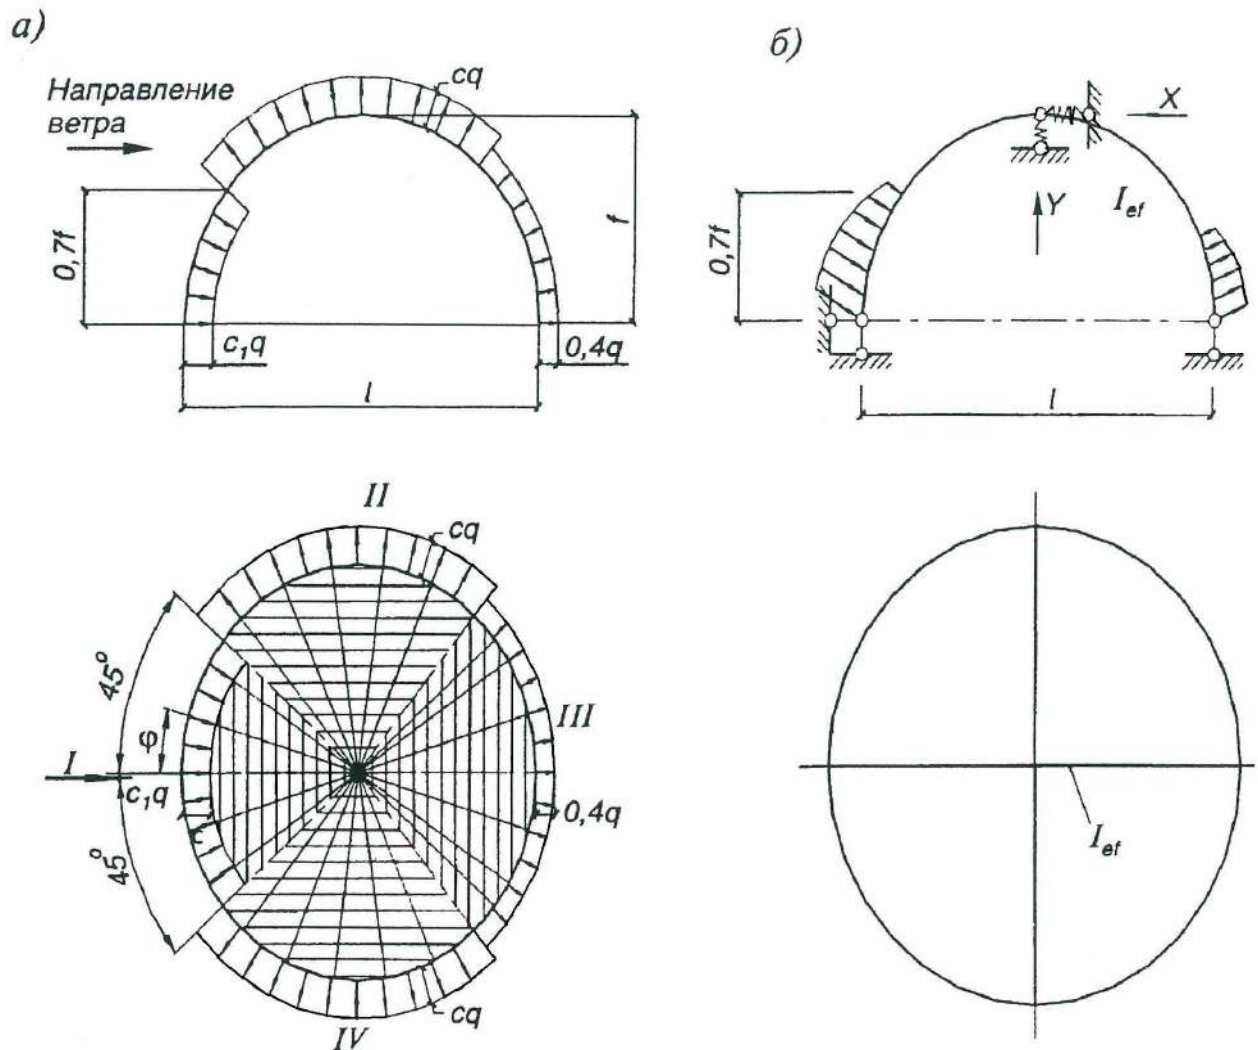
К расчету ребристого купола на ветровую нагрузку по [10, с. 287...288]: а – схема ветровой нагрузки, б – расчетная схема
